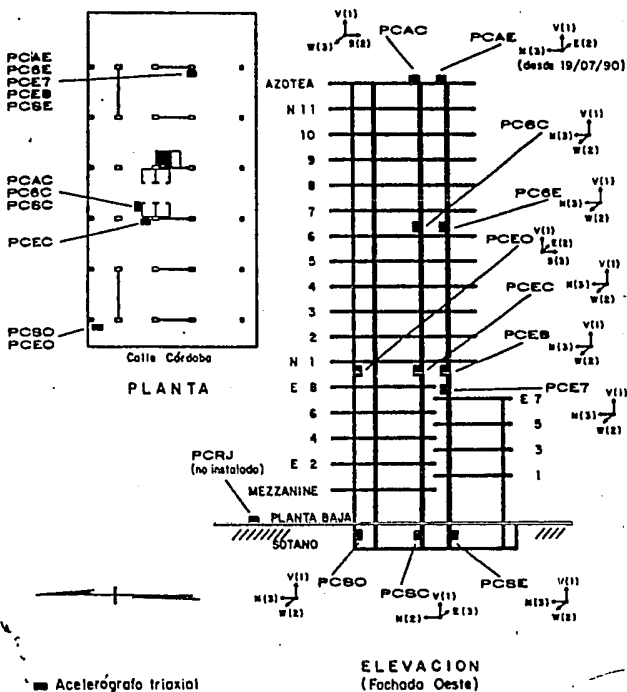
niveles en concreto reforzado, construido en la colonia Roma, sobre pilotes de fricción (ref 13).
